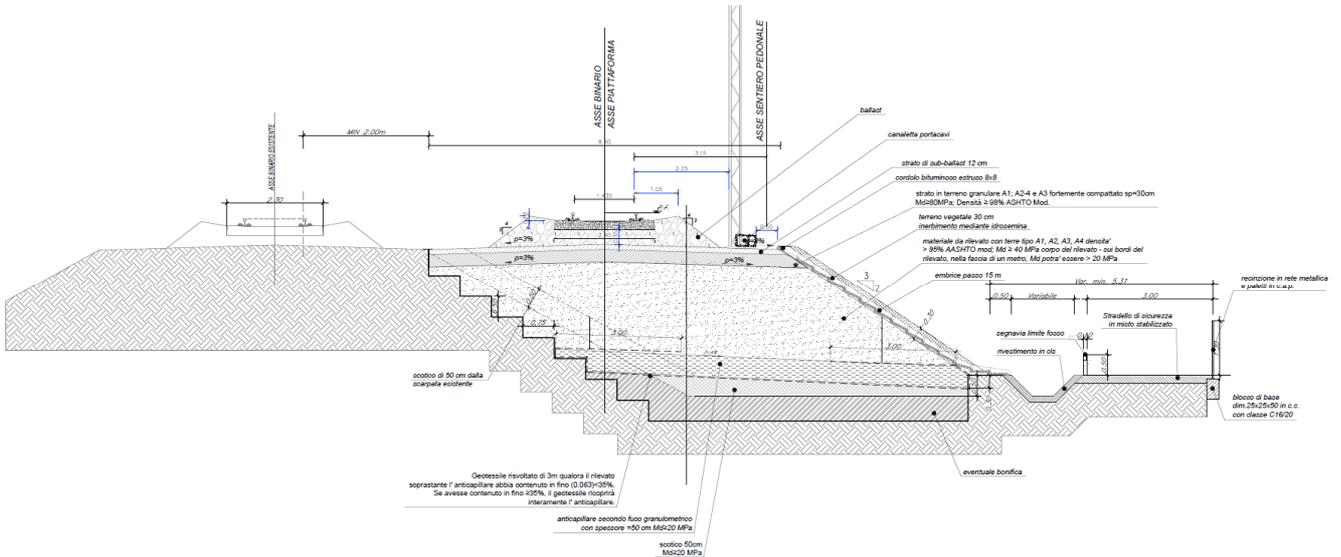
Sezione tipo in rilevato a SB, tratto in ammassamento al corpo stradale esistente
